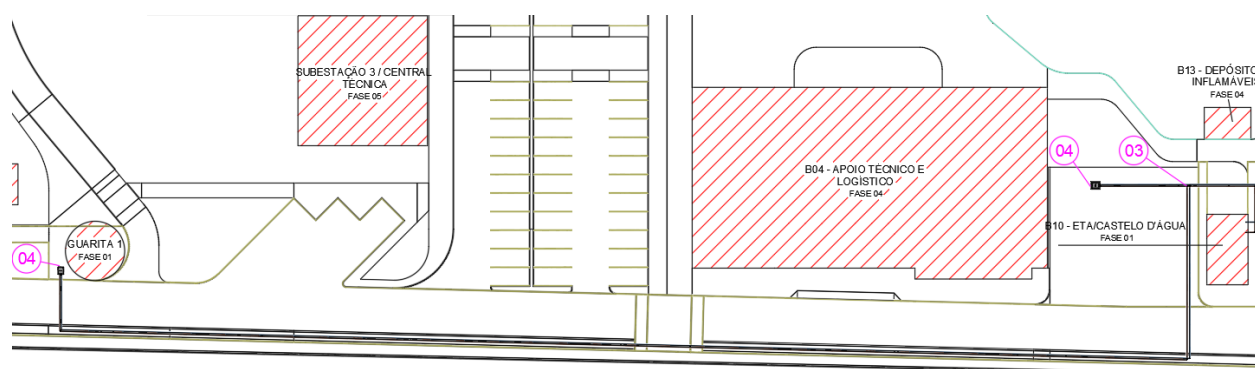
Planta trecho (Castelo d'água / Bloco B04 – Guarita 01)
